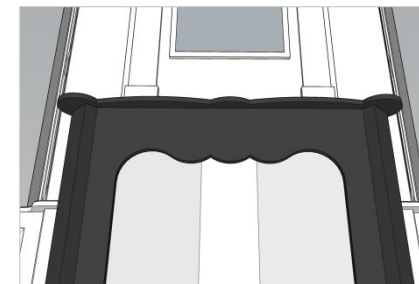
Detailfoto pilaster, bijv. foto (10)
